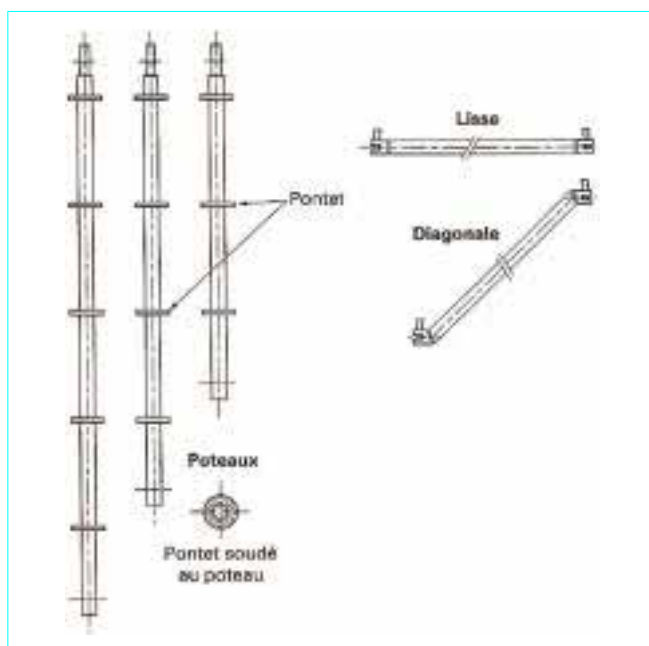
Exemple d'éléments d'échafaudage modulaire dit aussi multidirectionnel
